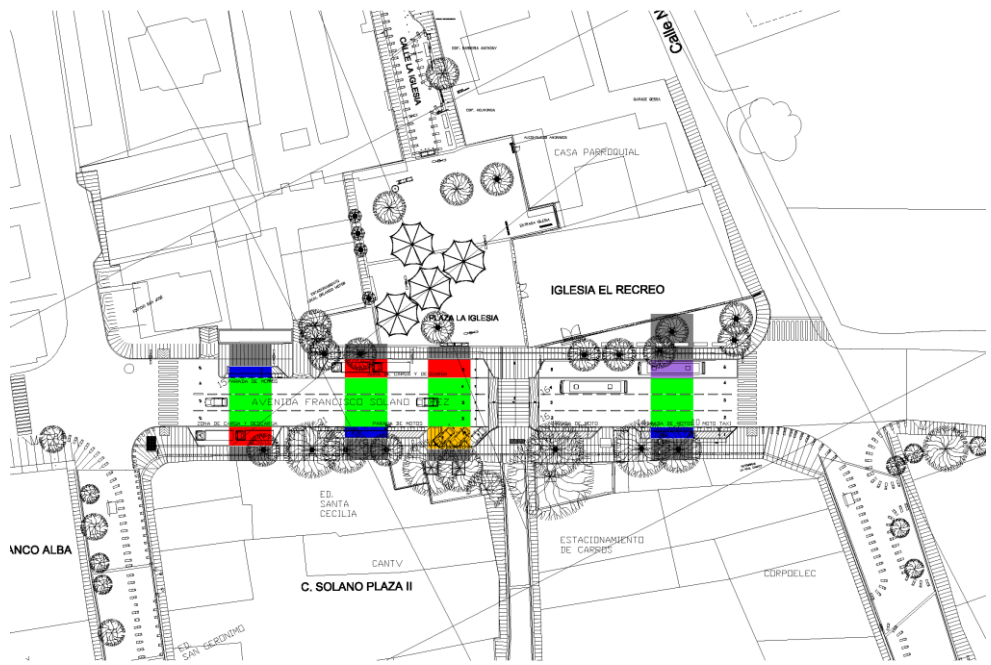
Plano y seccion, Plan Piloto de Ordenamiento Urbano de la Avenida Francisco Solano López.
